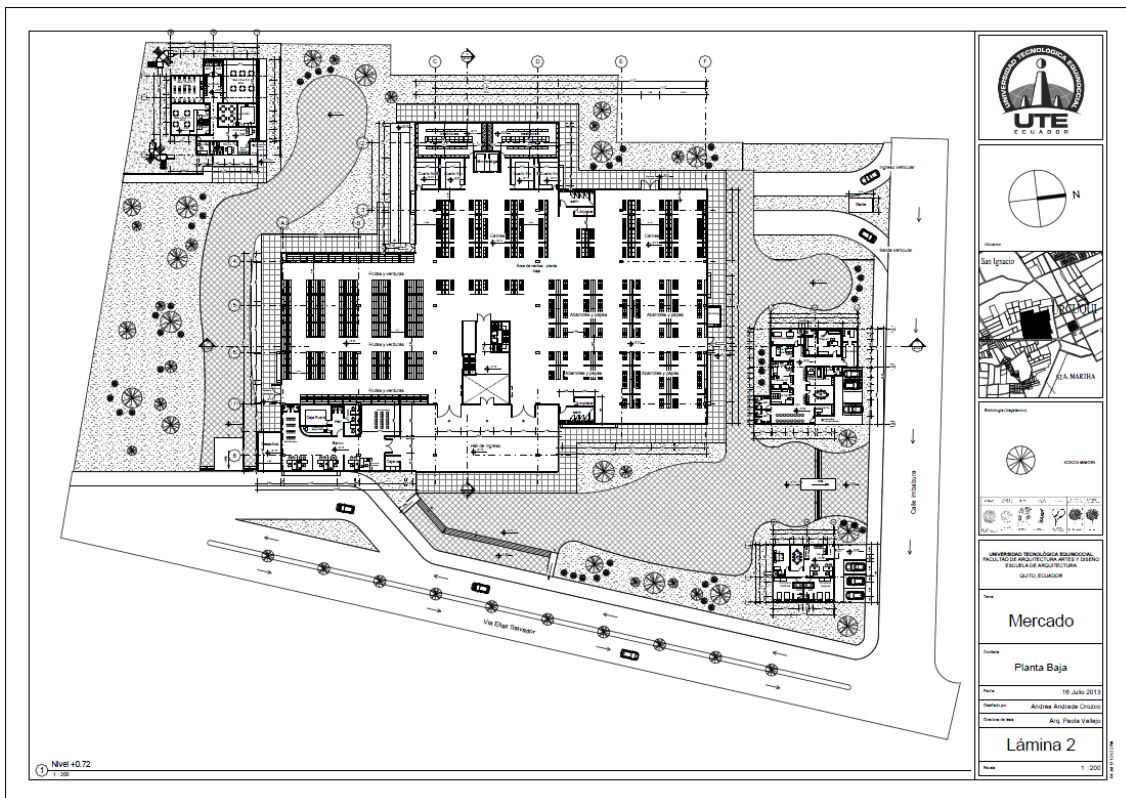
; PLANTA BAJA; Fuente: Andrea Andrade Orozco
